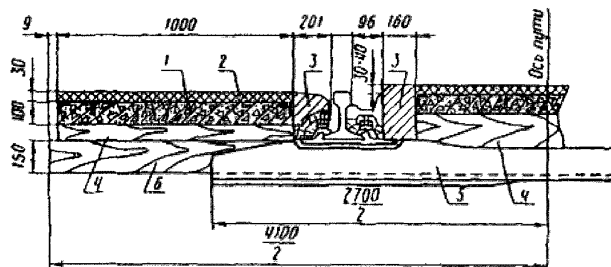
Деталь желоба между путевым рельсом и железобетонным настилом переезда с контррельсом (размеры даны в мм):
